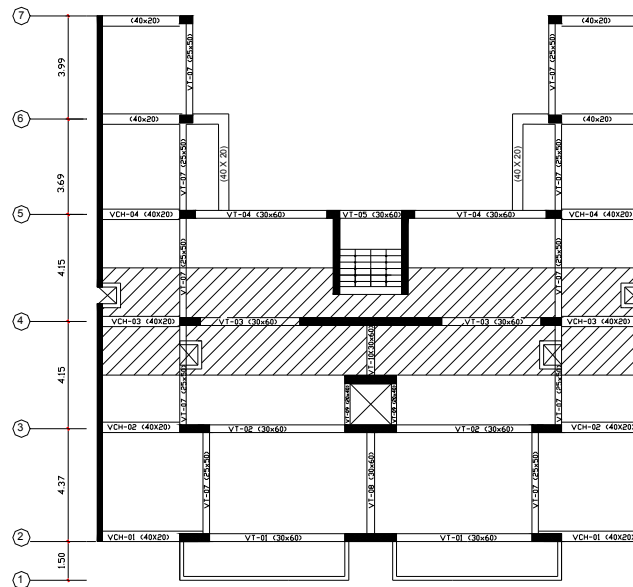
Ubicación en planta de la Viga típica V-03 del eje 4.
